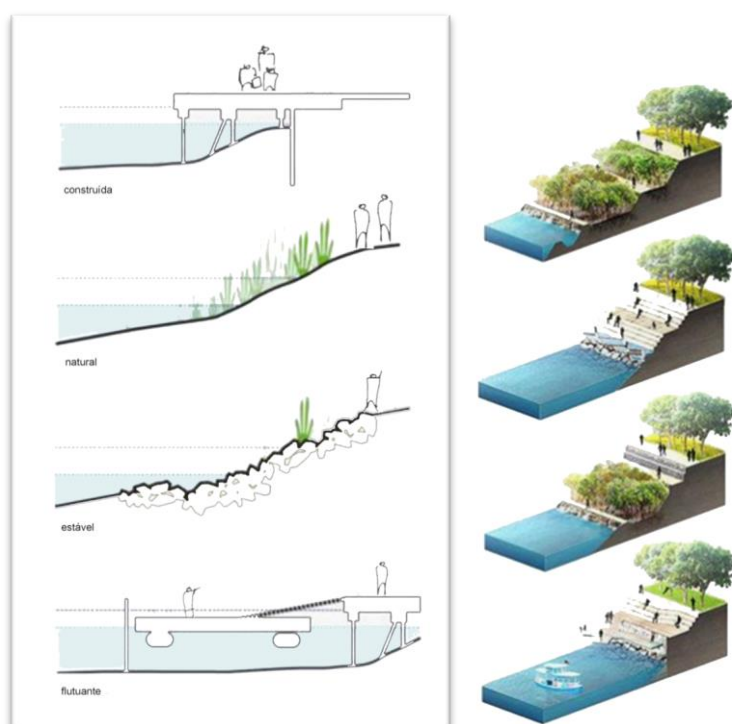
Ilustração de barreiras existentes e intervenções conceptuais
